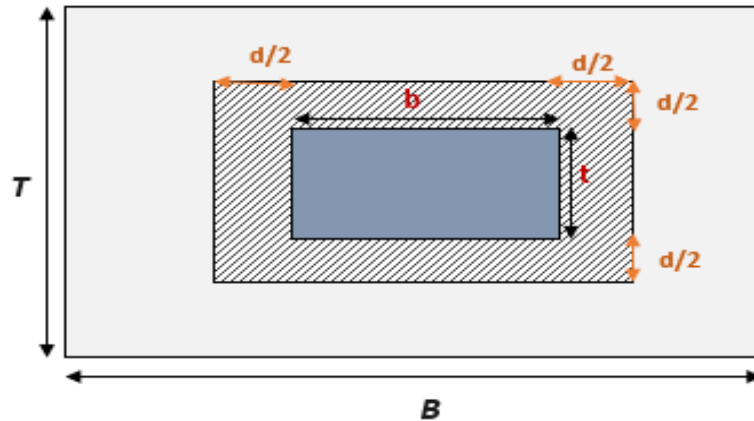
Esquema zapata, columna y zona de punzonamiento. Elaborada por la autora.
